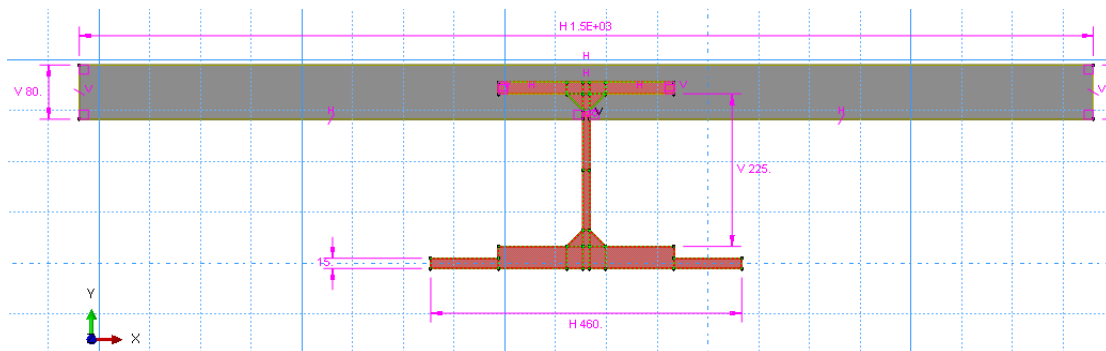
Sketch da secção da viga SFB e laje de betão do pavimento de 30 cm.
